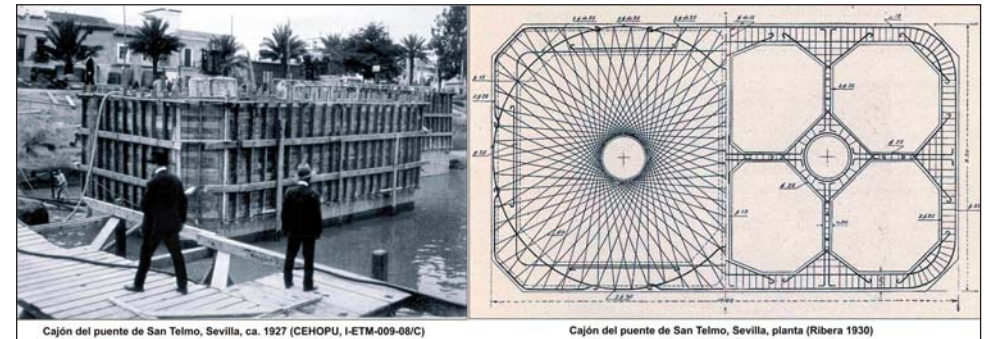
Izquierda, cajón de hormigón del puente de San Telmo flotando sobre el río, hacia 1927 (Archivo E.Torroja, CEHOPU, I-ETM-009-08/C, en: www.cehopu.cedex/etm/I-ETM-009-08.htm). Derecha, planta de cajón de hormigón del puente de San Telmo (RIBERA 1930:195).
